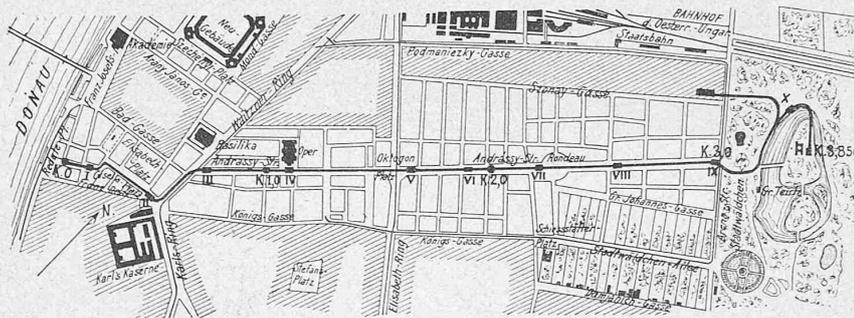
Lageplan mit Tracé. — Masstab 1 : 30000.
